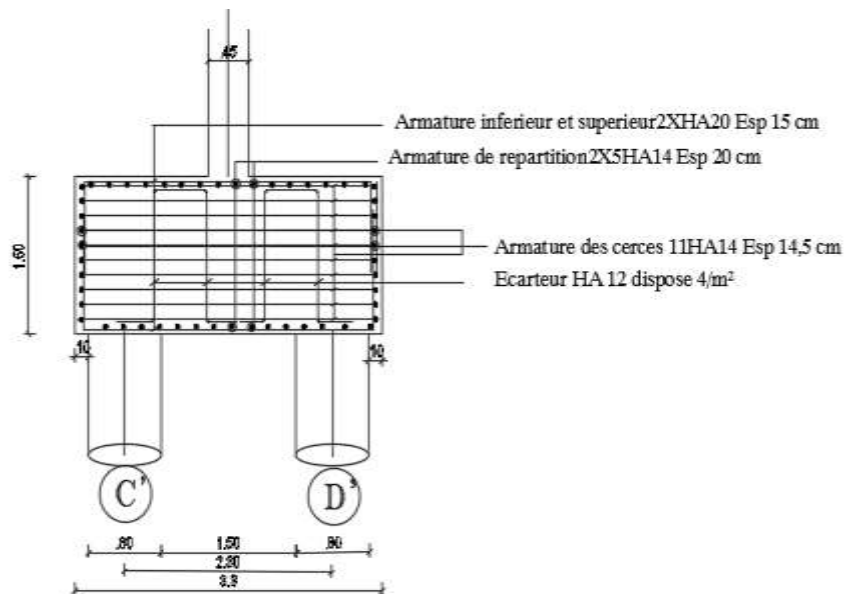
Coupe verticale de ferrailage de la semelle sur 4 pieux
